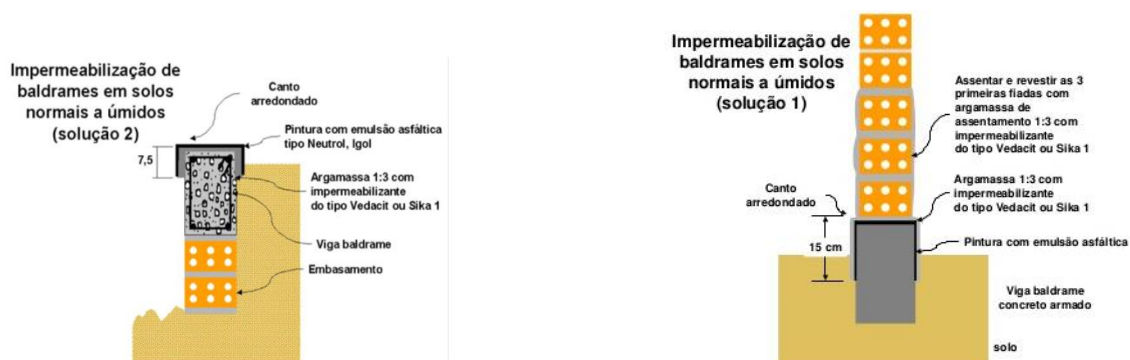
Sistemas modelos para Impermeabilização de dos elementos de fundação
